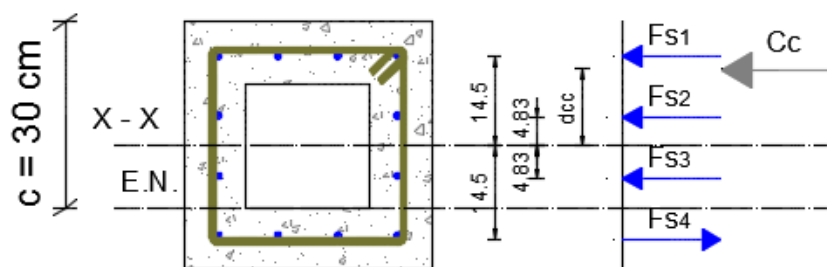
Esquema general de deformaciones, esfuerzos y fuerzas en la sección transversal cuadrada
